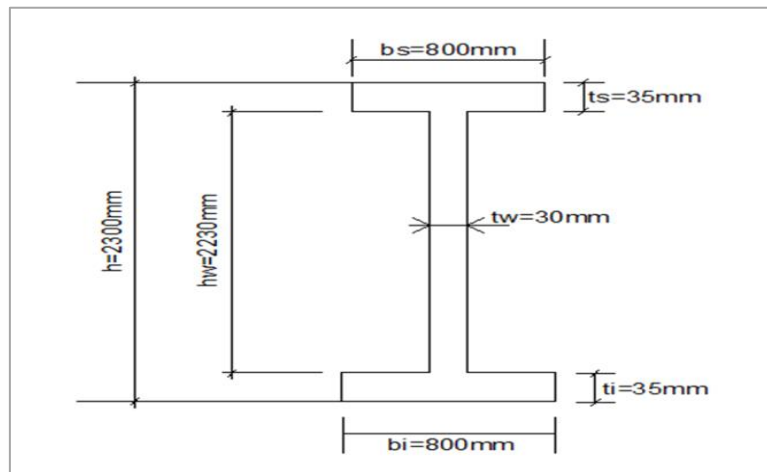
Caractéristiques des poutres principales (PRS) du pont
